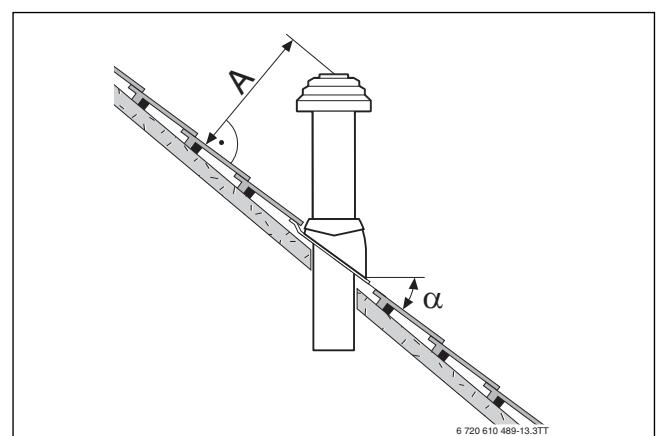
Abstandsmaße und Dachneigungen bei Schrägdach
